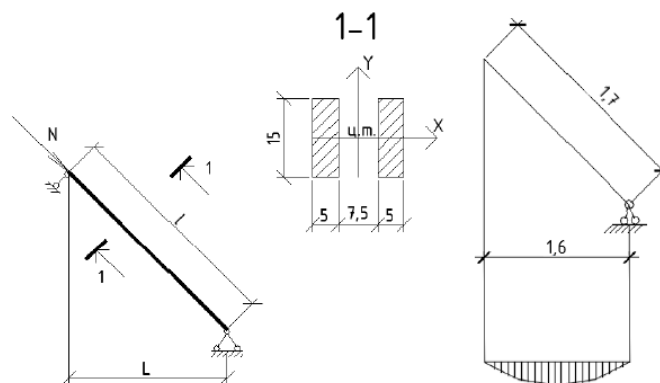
Расчётная схема подкоса стропильной ноги
